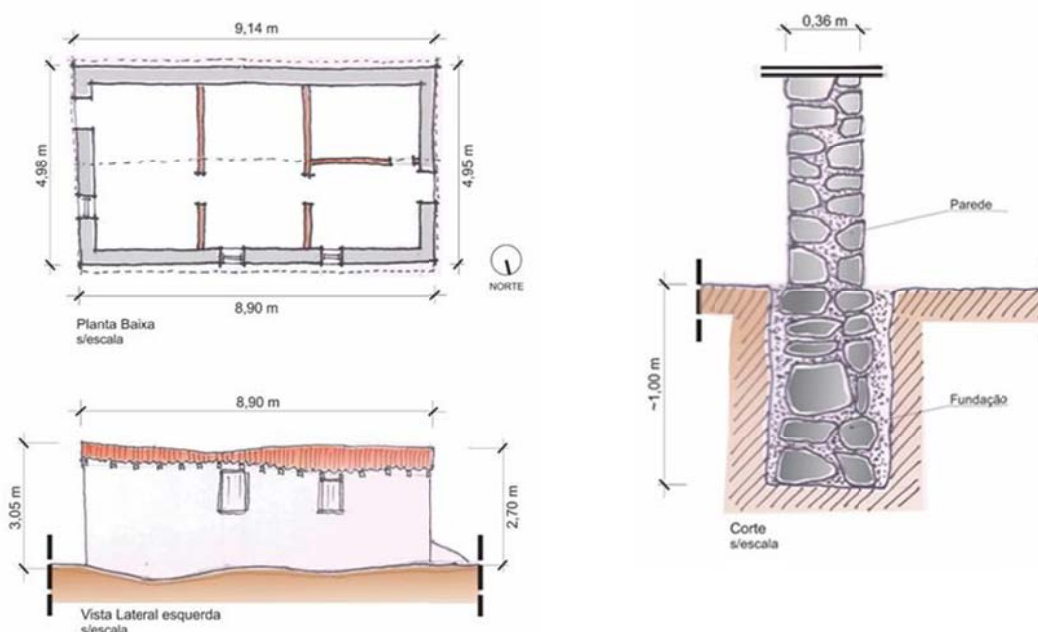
Planta baixa, vista lateral e detalhe da alvenaria de rocha de residência em Pesqueira-PE.
